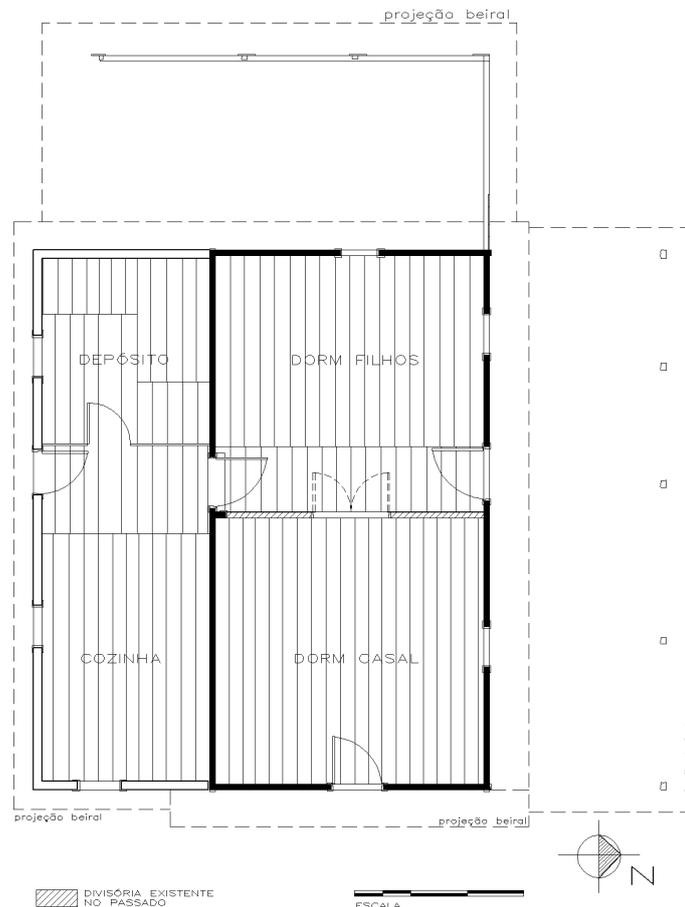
PLANTA BAIXA, COM A DIVISÃO INTERNA E A INDICAÇÃO DA PAREDE INEXISTENTE
